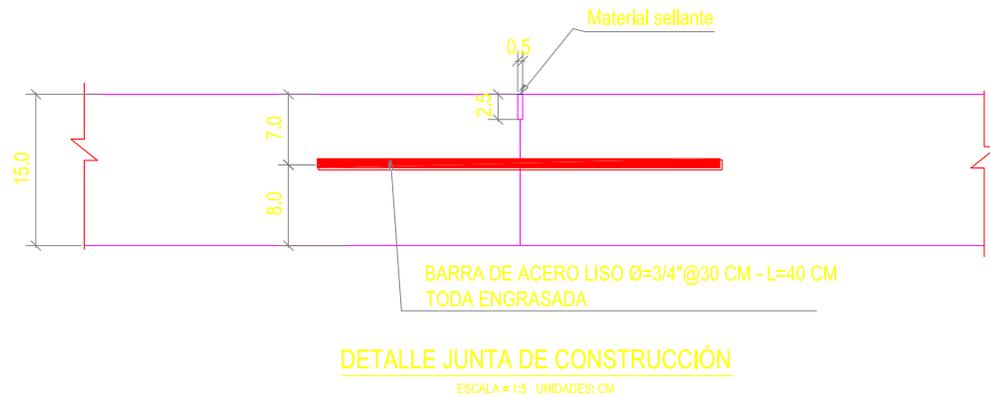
Detalle junta de construcción. (Fuente: departamento de diseño Metálicas e ingeniería S.A.)
